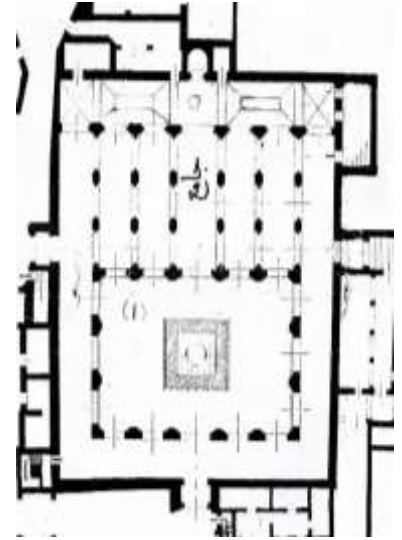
مسقط أفقي لجامع المواسين بمراكش
